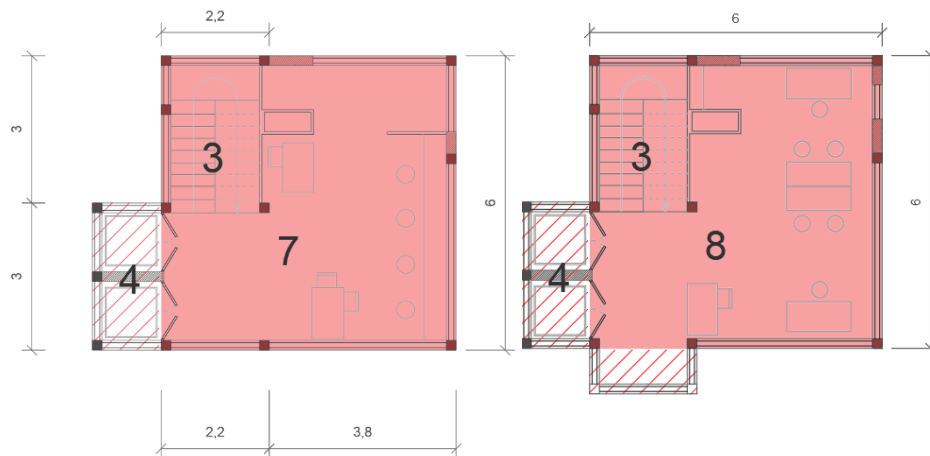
Planimetrías de la tercera y la cuarta planta.
